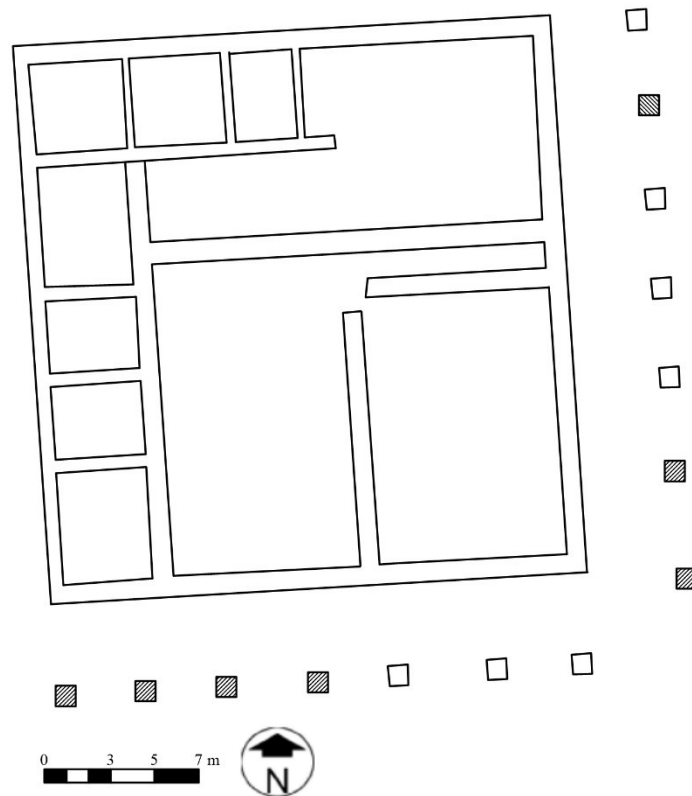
Planimetria semplificata dell'edificio porticato. La posizione dei pilastri in grigio è soltanto supposta (Elaborazione dell'Autore).
